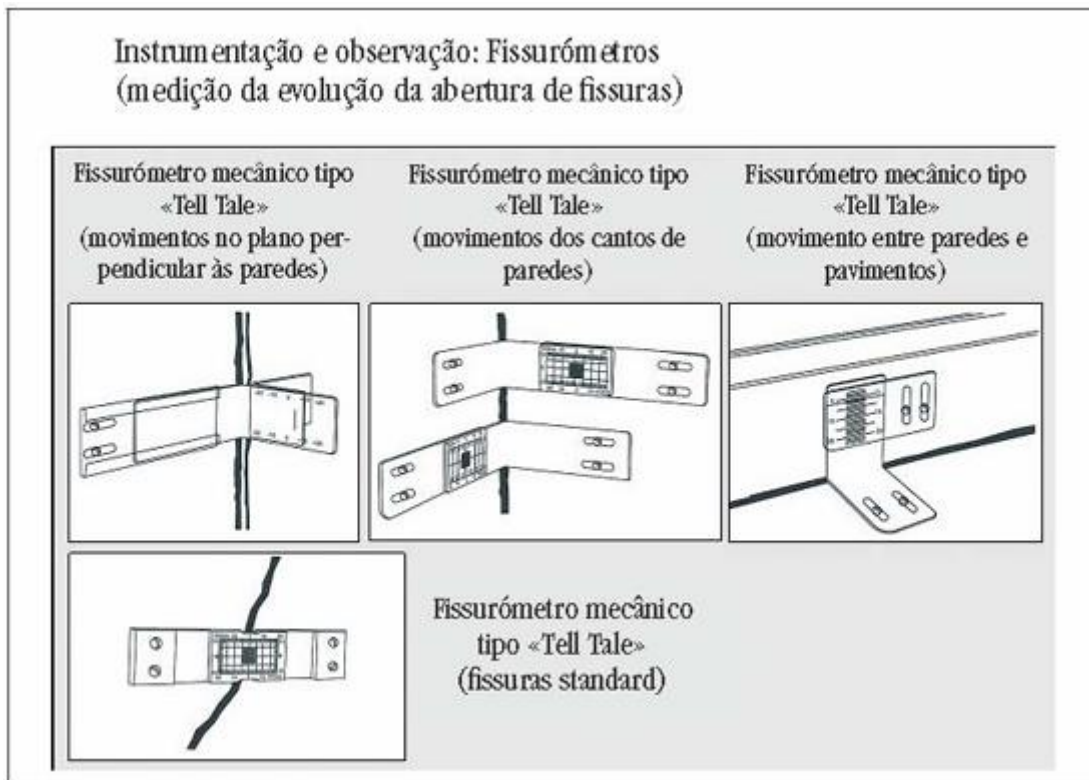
Fissurómetro para medição da evolução de aberturas e fissuras
